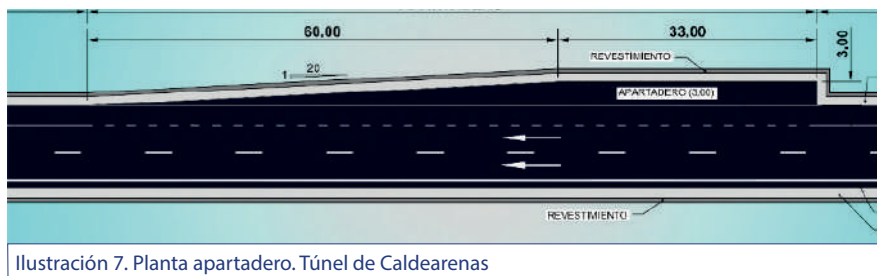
Planta apartadero. Túnel de Caldearenas
